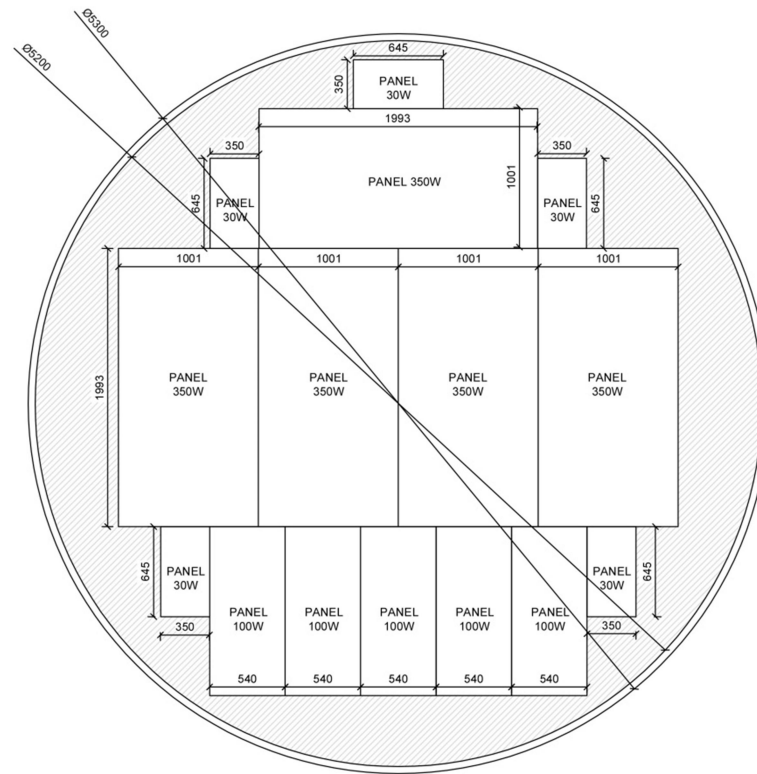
Panel solar integrado. Planta distribución elementos s/e.
